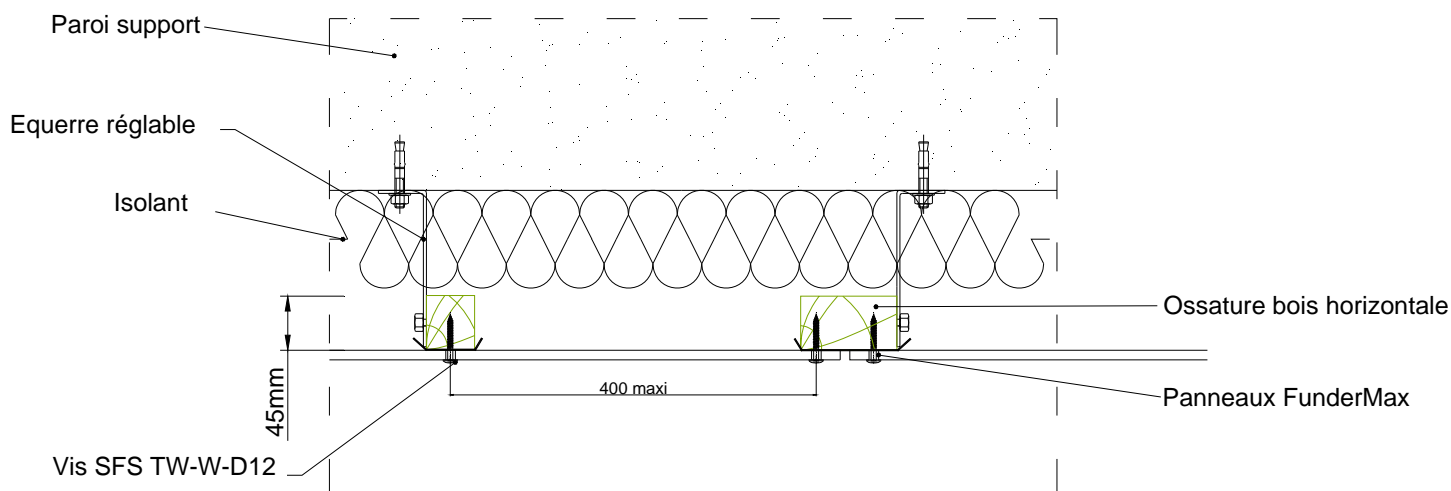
Pose en sous-face – Coupe verticale avec isolant
